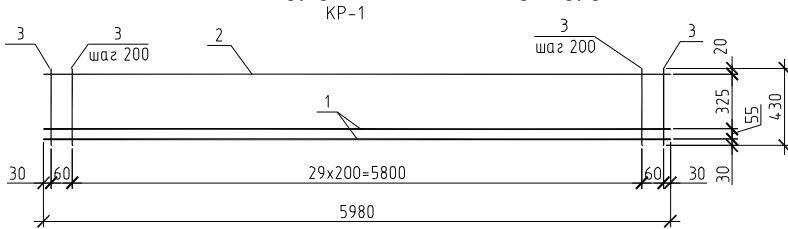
Конструирование элемента (к примеру расчета 4).
